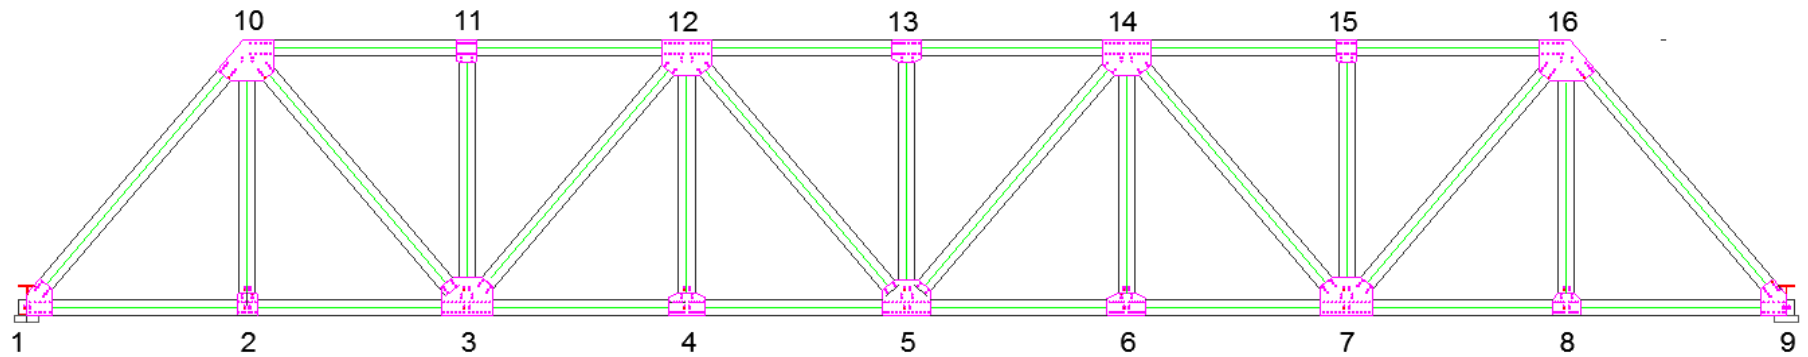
VISTA LATERAL DERECHO DE LA ARMADURA
